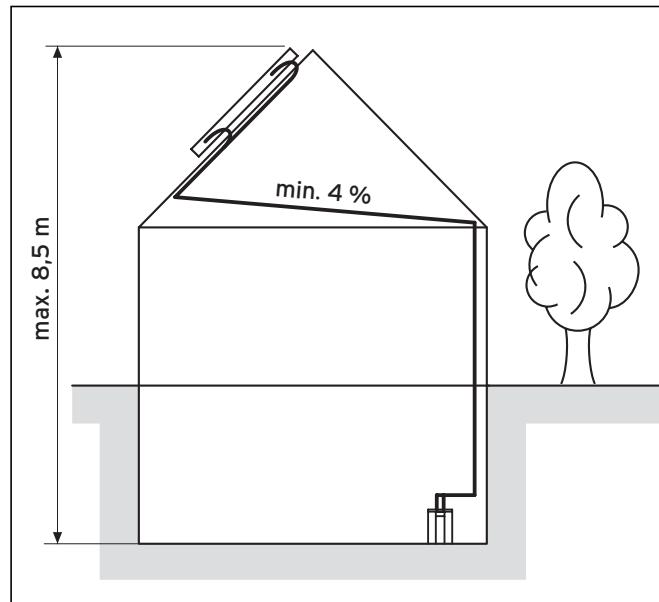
Hauteur de l'installation et inclinaison des conduites sans « cuve retour solaire »
